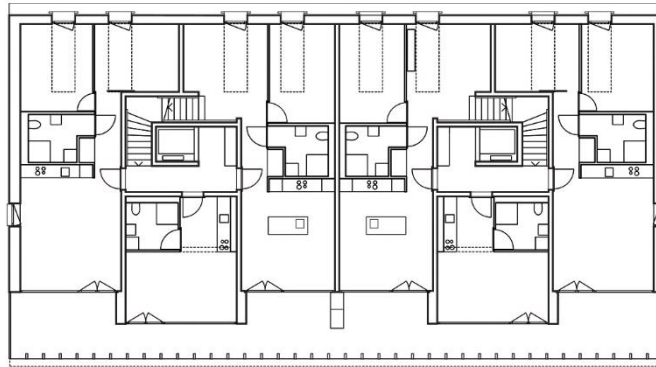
План першого поверху[<https://www.archdaily.com/872884/two-residential-buildings-a-boarding-school-and-an-activity-centre-bunq-architectes>]
